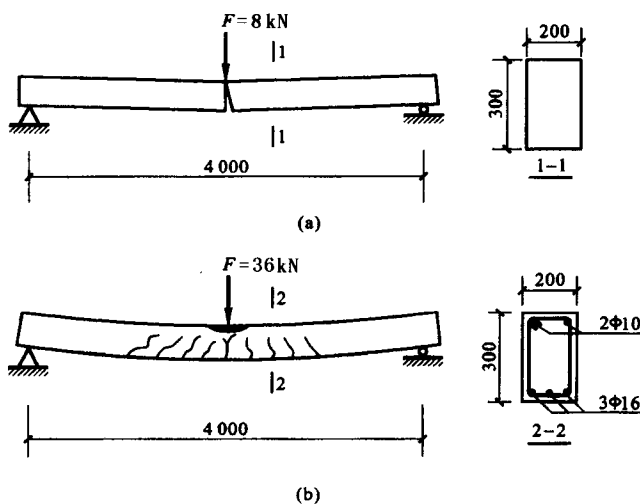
素混凝土梁与钢筋混凝土梁的破坏情况
